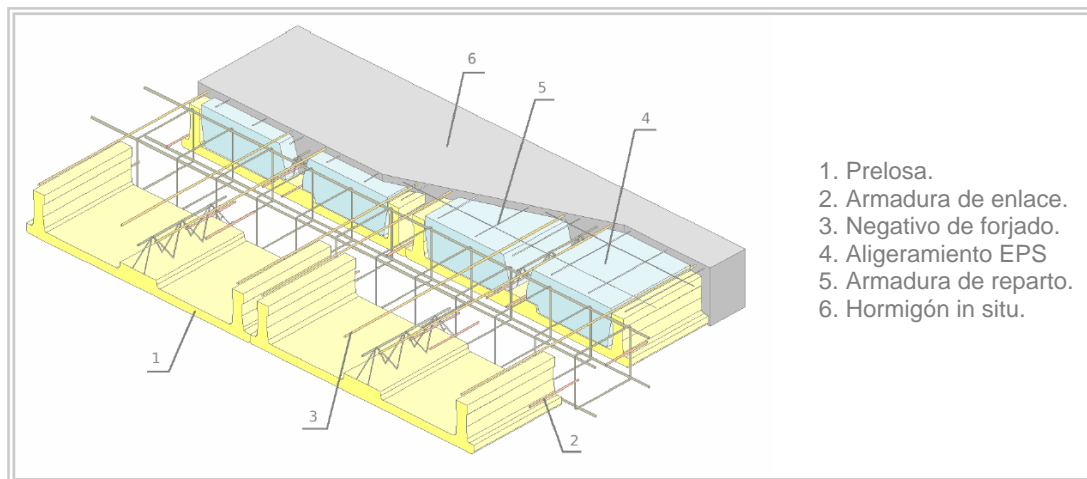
Esquema de prelosa prefabricada con aligeramiento de EPS. (Prefabricados Castelo)
